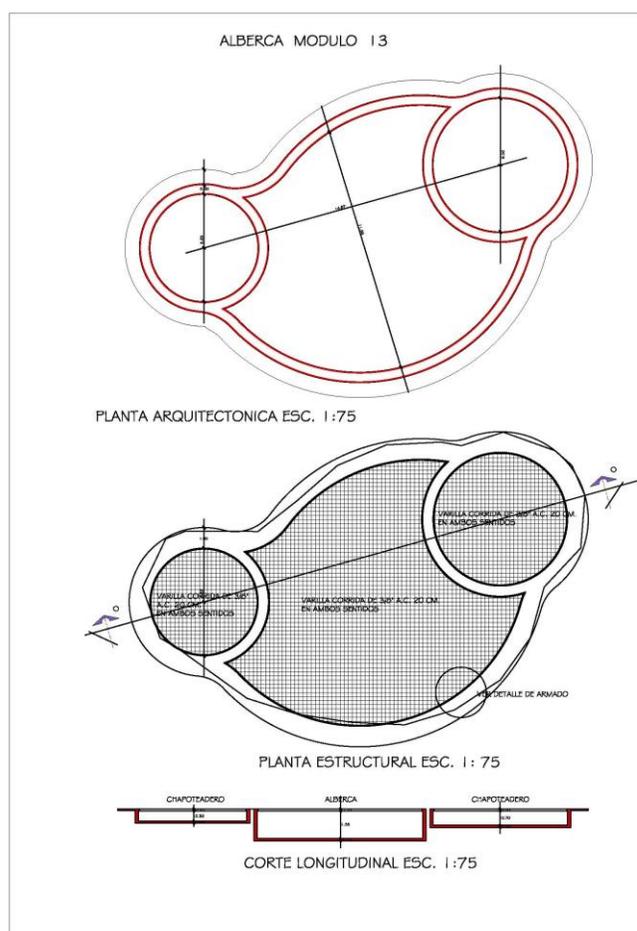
Plano arquitectónico de la alberca del módulo 13.
